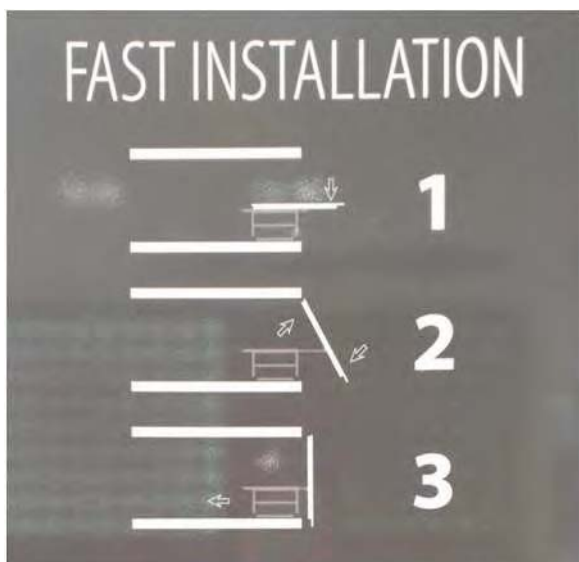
Instalación del sistema modular de fachada. Butech, Porcelanosa Grupo, año 2016
